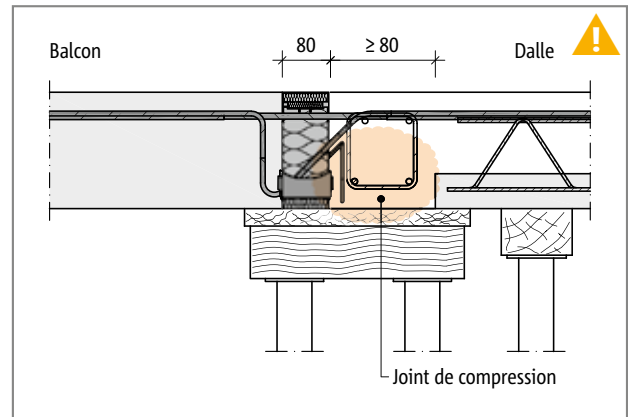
Schöck Isokorb® T Type K-E, K-T : Installation sur plancher en prédalles avec poutres de rive, joint de dilatation côté plancher
